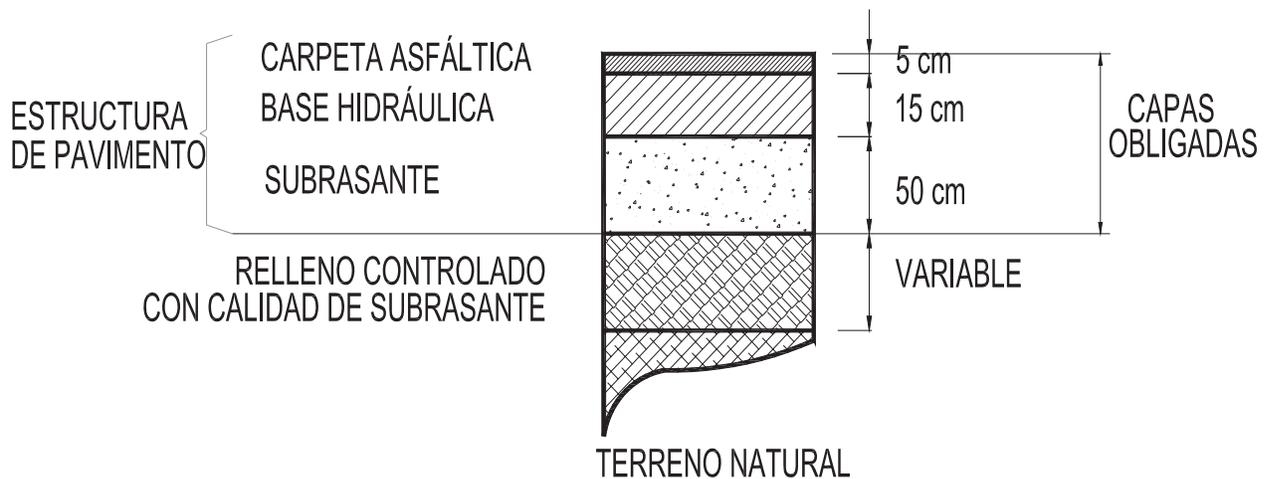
Estructura de pavimento flexible en zona de estacionamiento.
